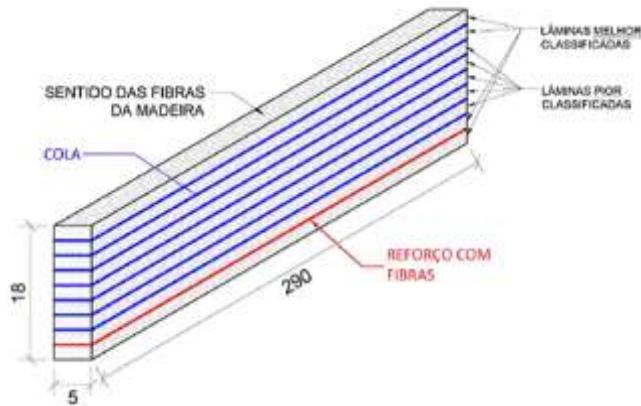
Esquema de montaje de las vigas probadas – fuente: Saldanha (2018).
